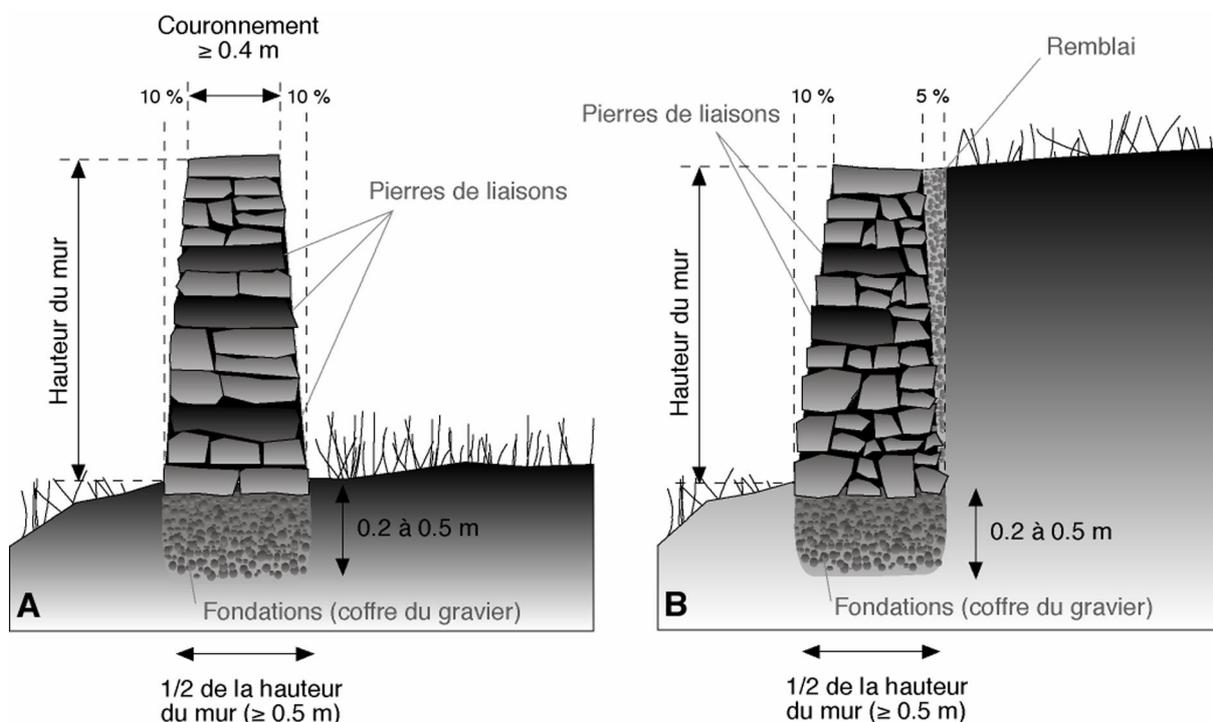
dimensions d'un mur de pierres sèches. A: mur sans fonction de soutènement, B: mur de soutènement.
